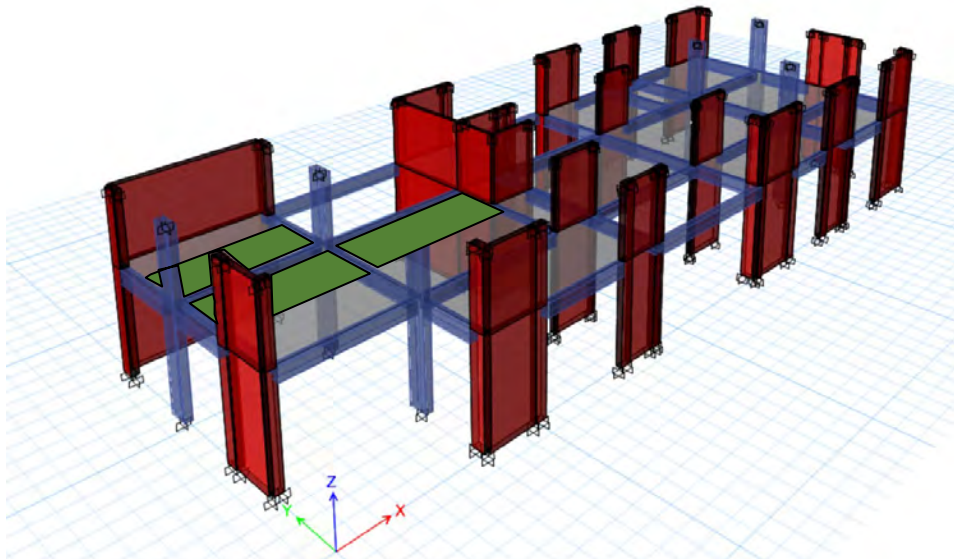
Planta aislada para cálculo de fuerzas internas de C_m y C_v
